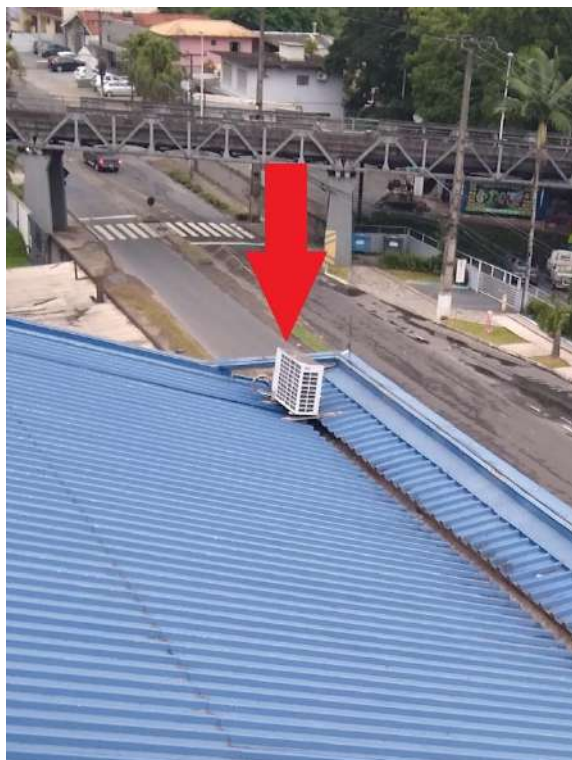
Compressor do ar condicionado instalado fora da zona de proteção do SPDA.
